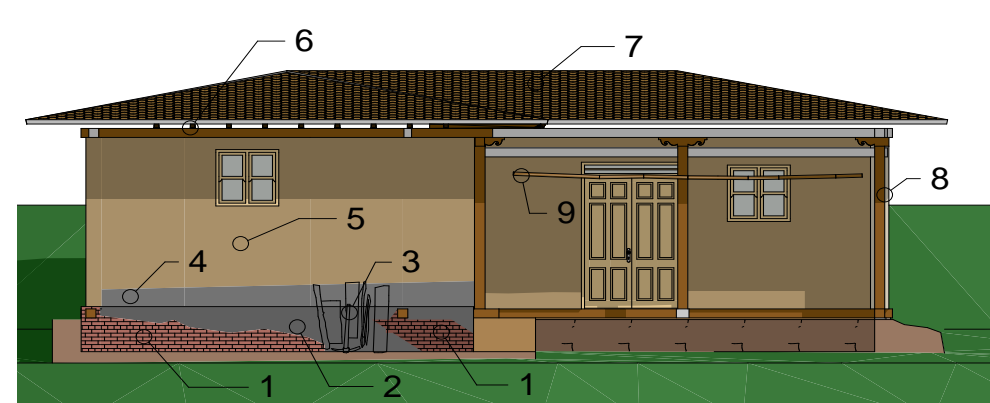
Fachada frontal. Casa de Manuel Guamán. Fuente: Investigador
